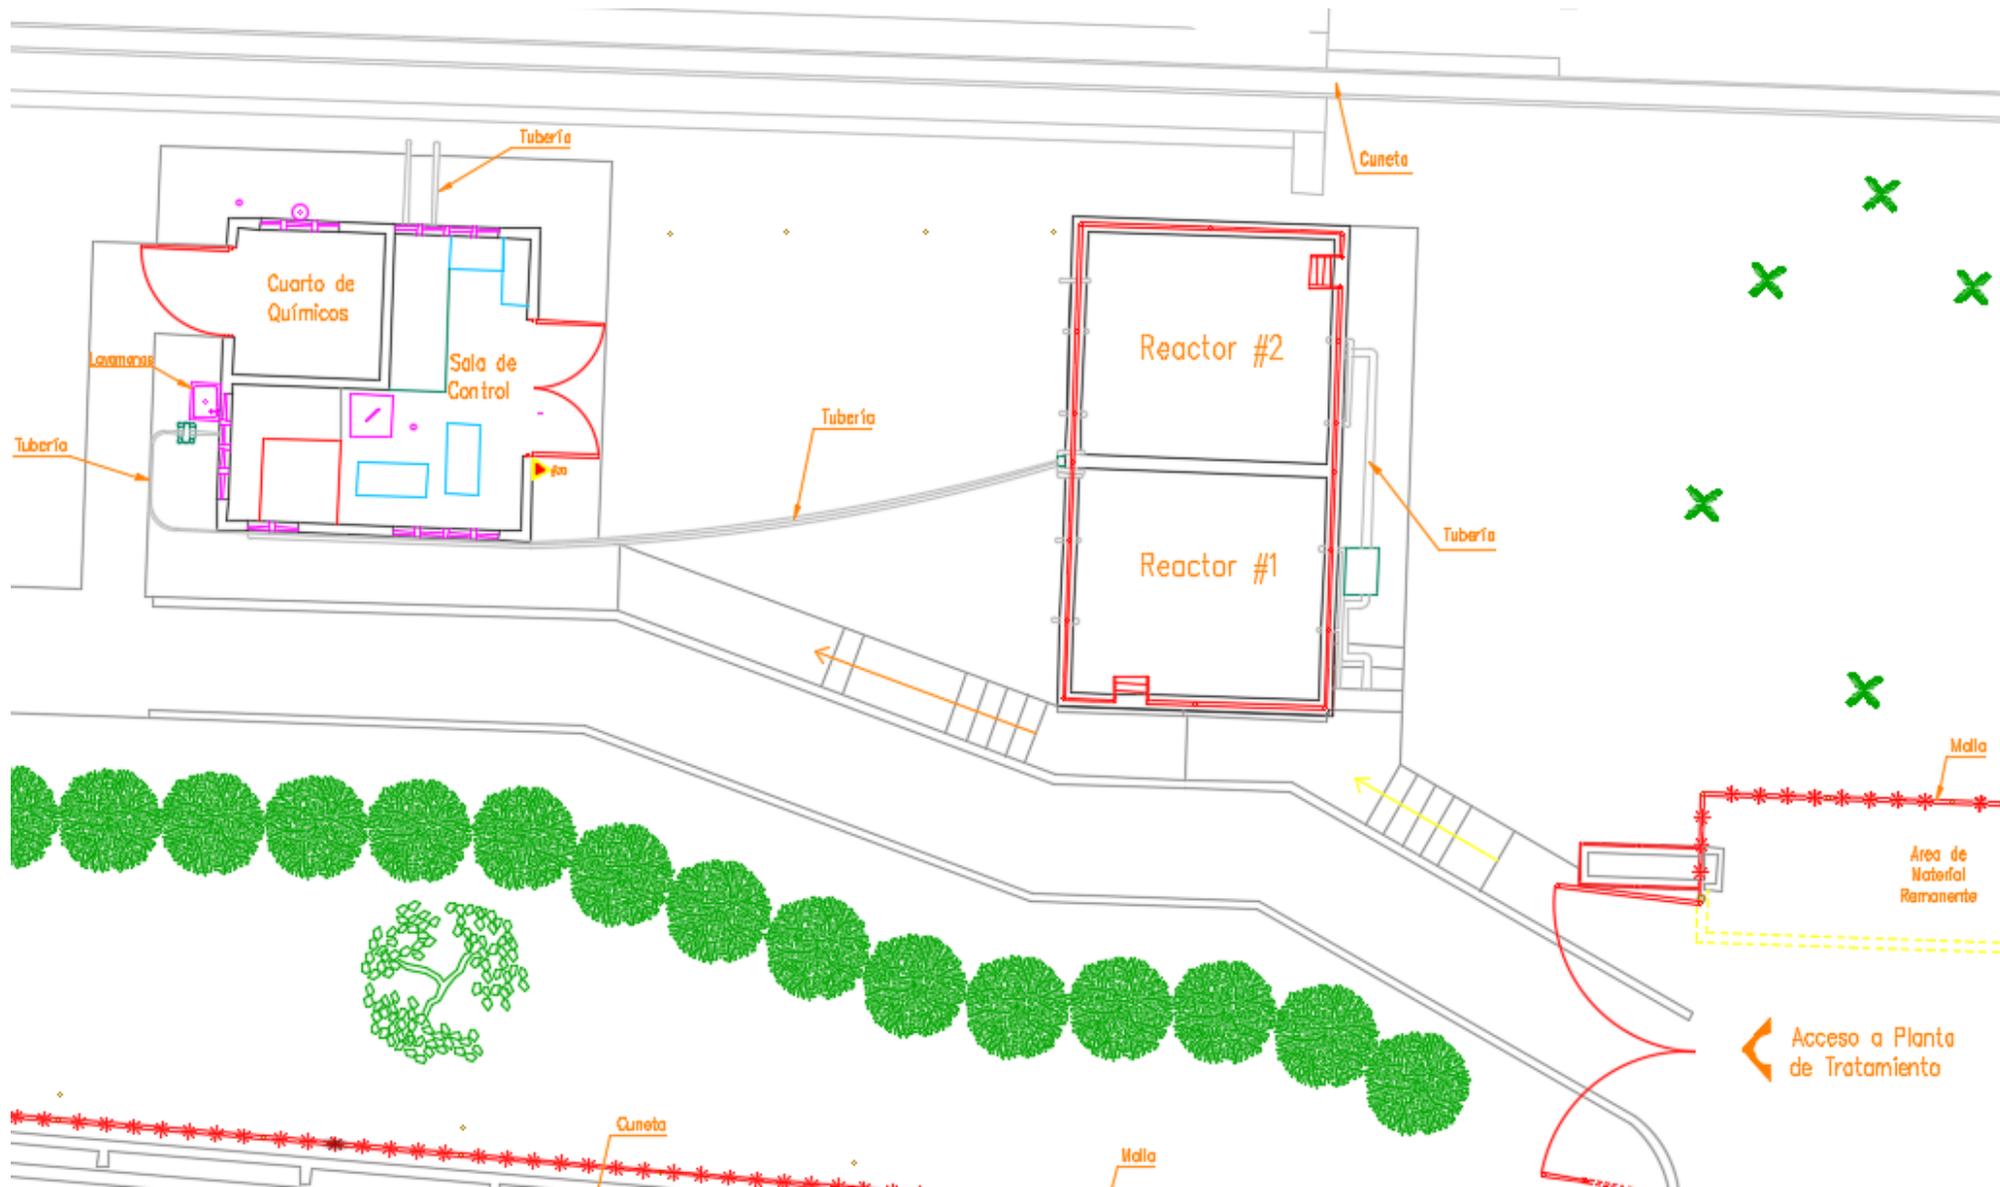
Plano Planta Eaton Electrical VR brindado por Eaton Electrical S.A.
